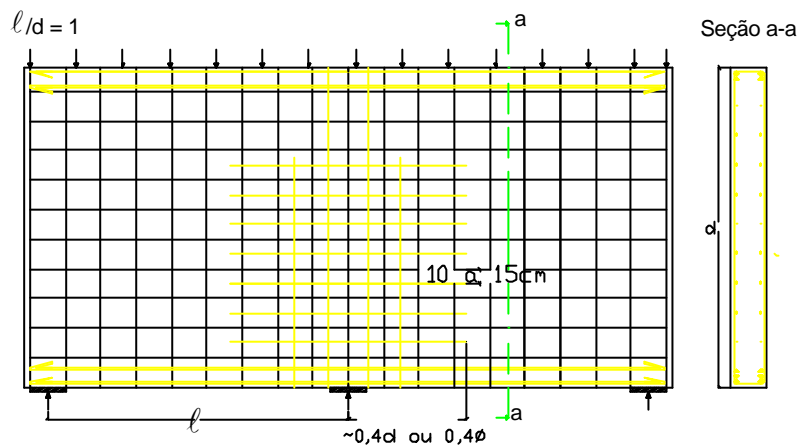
Exemplos de disposição de armaduras em viga-parede com dois tramos.
